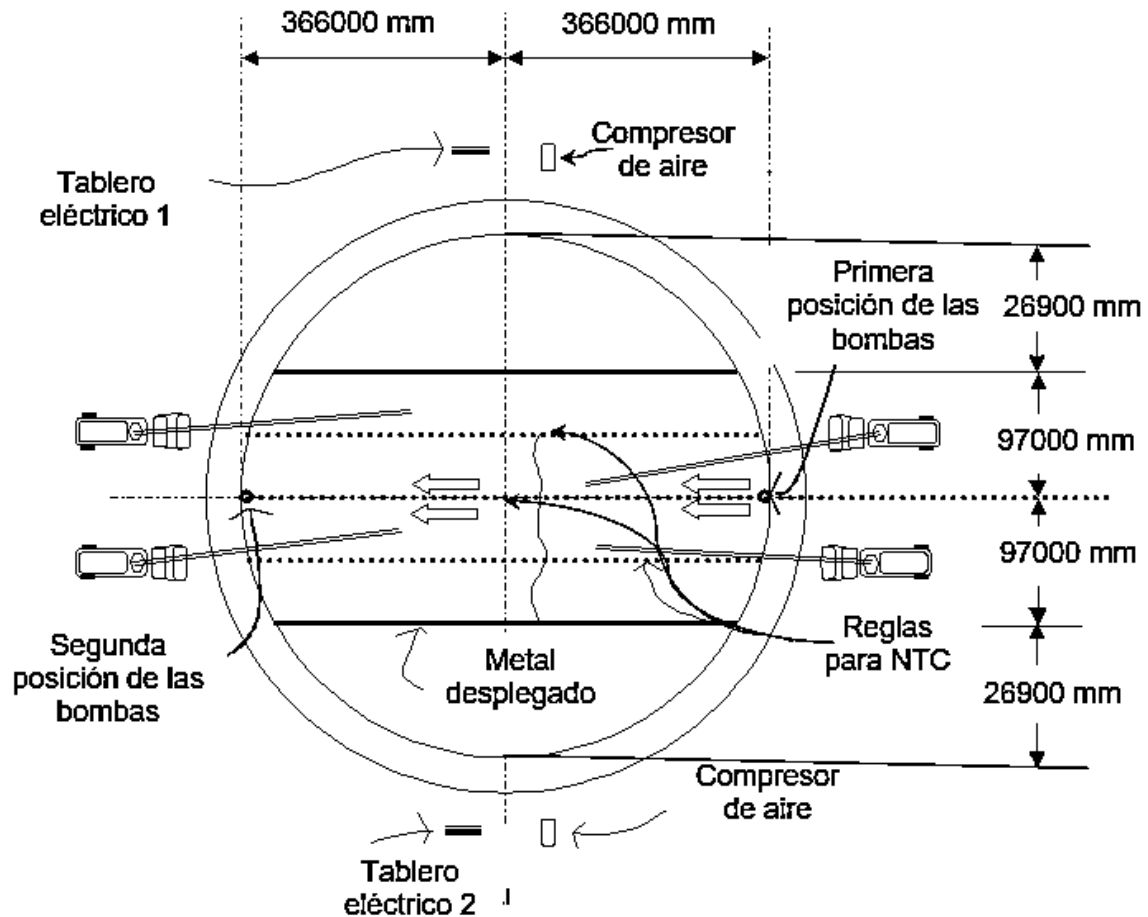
Diagrama de secuencia para el colado de la losa de cimentación.
